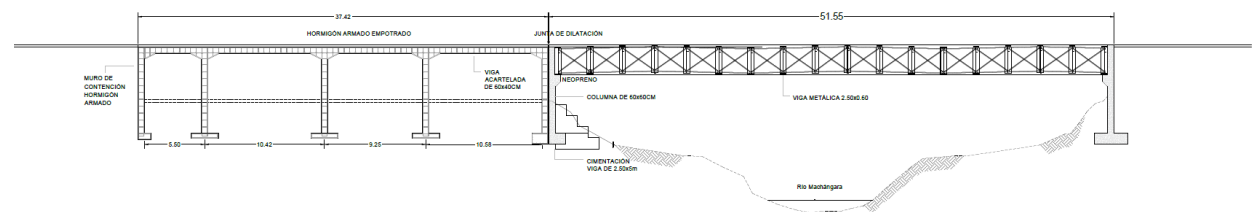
Detalle constructivo corte longitudinal puente (elaboración propia)
